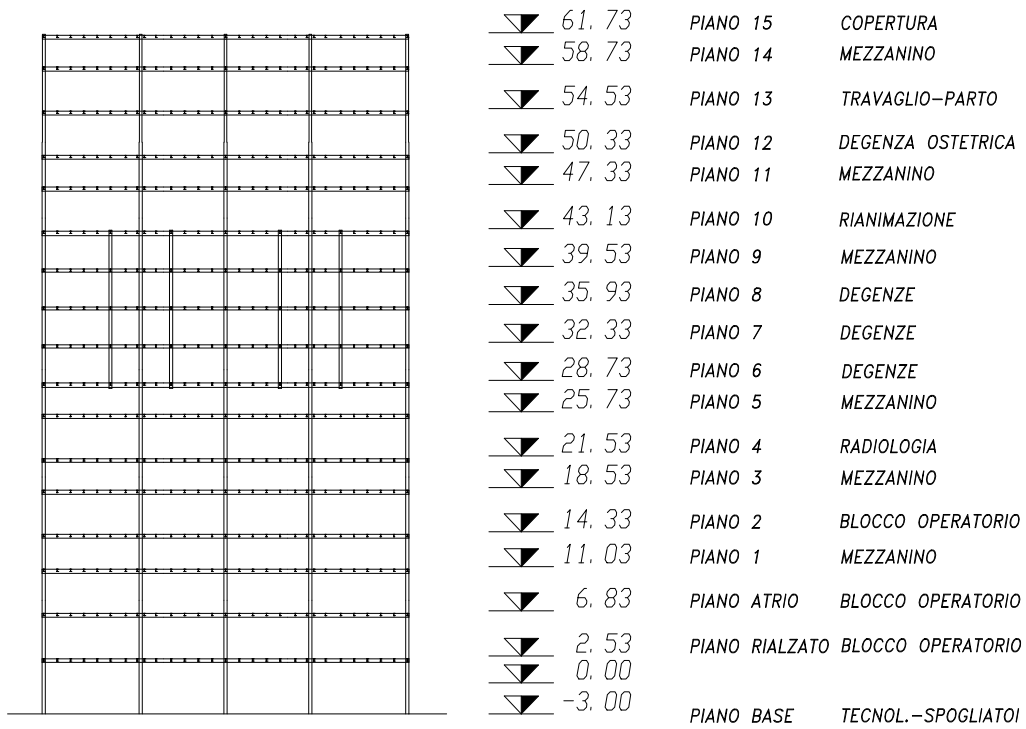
Prospetto trasversale (E-O) del Corpo D
